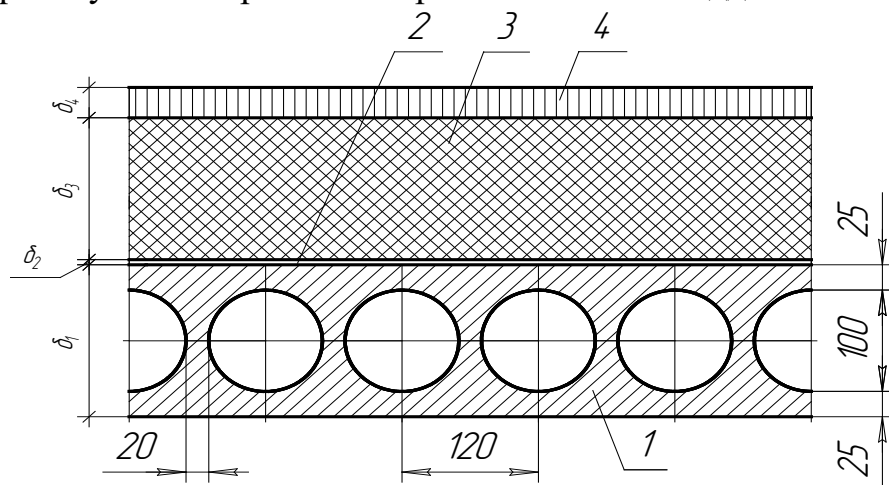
Схема до розрахунку горищного перекриття на знаходження термічного опору: 1 – багатопустотна залізобетонна плита; 2 – пароізоляція; 3 – утеплювач; 4 – вирівнюючий шар.
